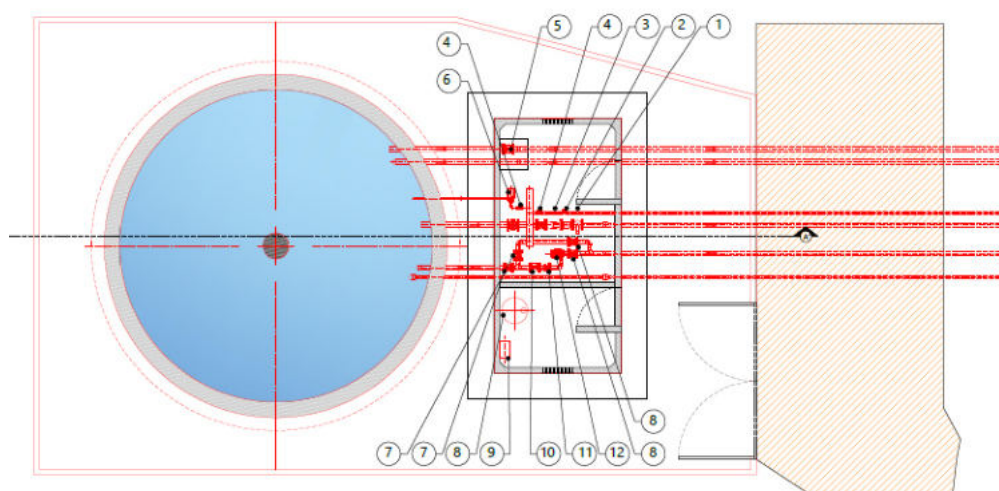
Detall en planta del recinte del dipòsit i la caseta de vàlvules
